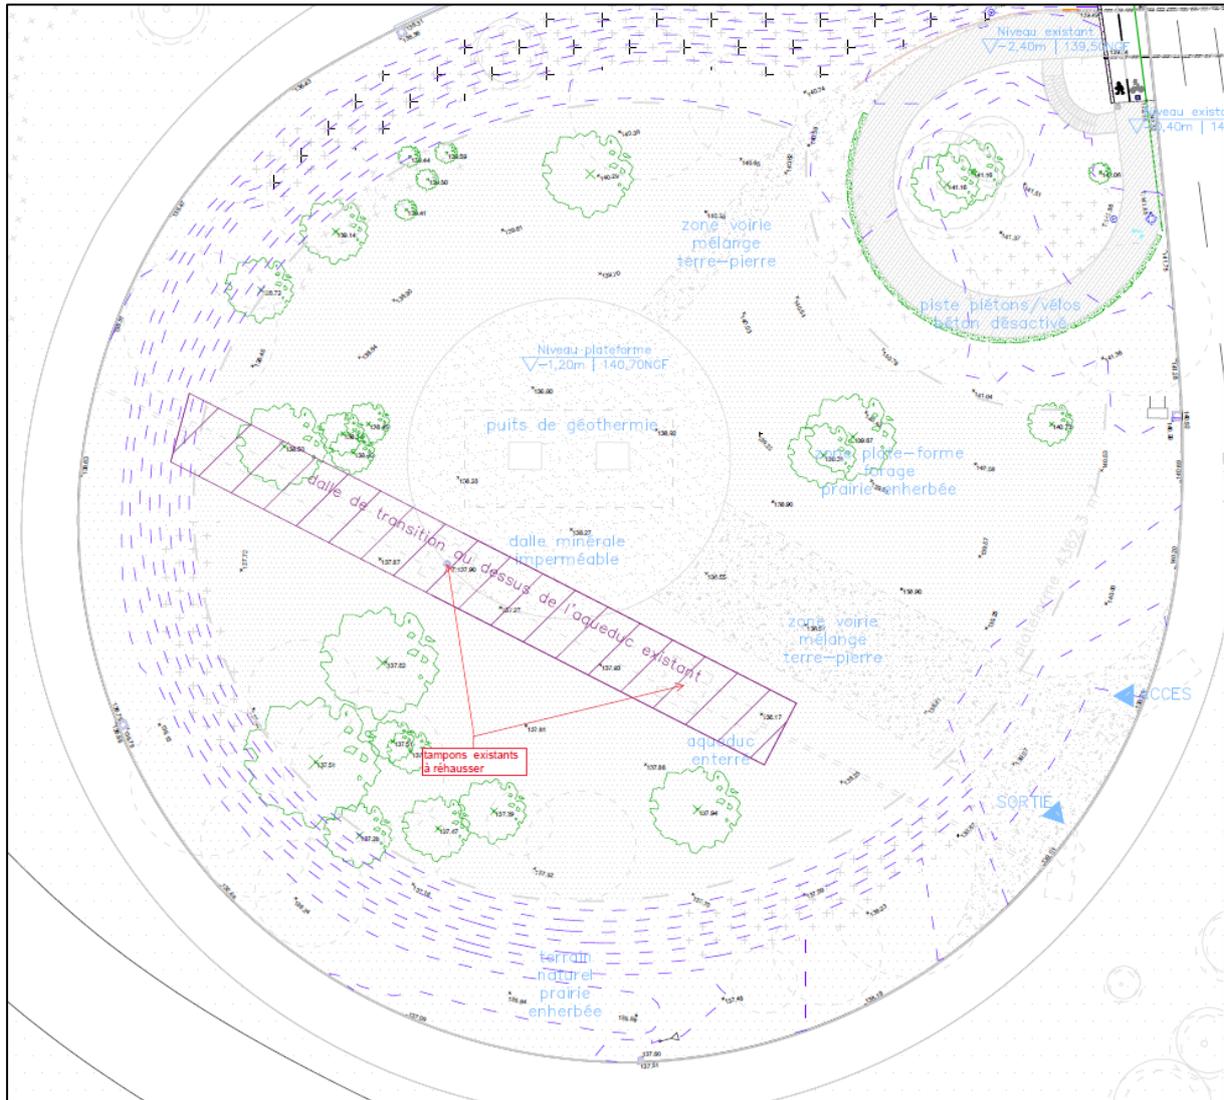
Plan d'implantation de la dalle béton au-dessus de l'aqueduc (Source : Sodeba Ginko)
